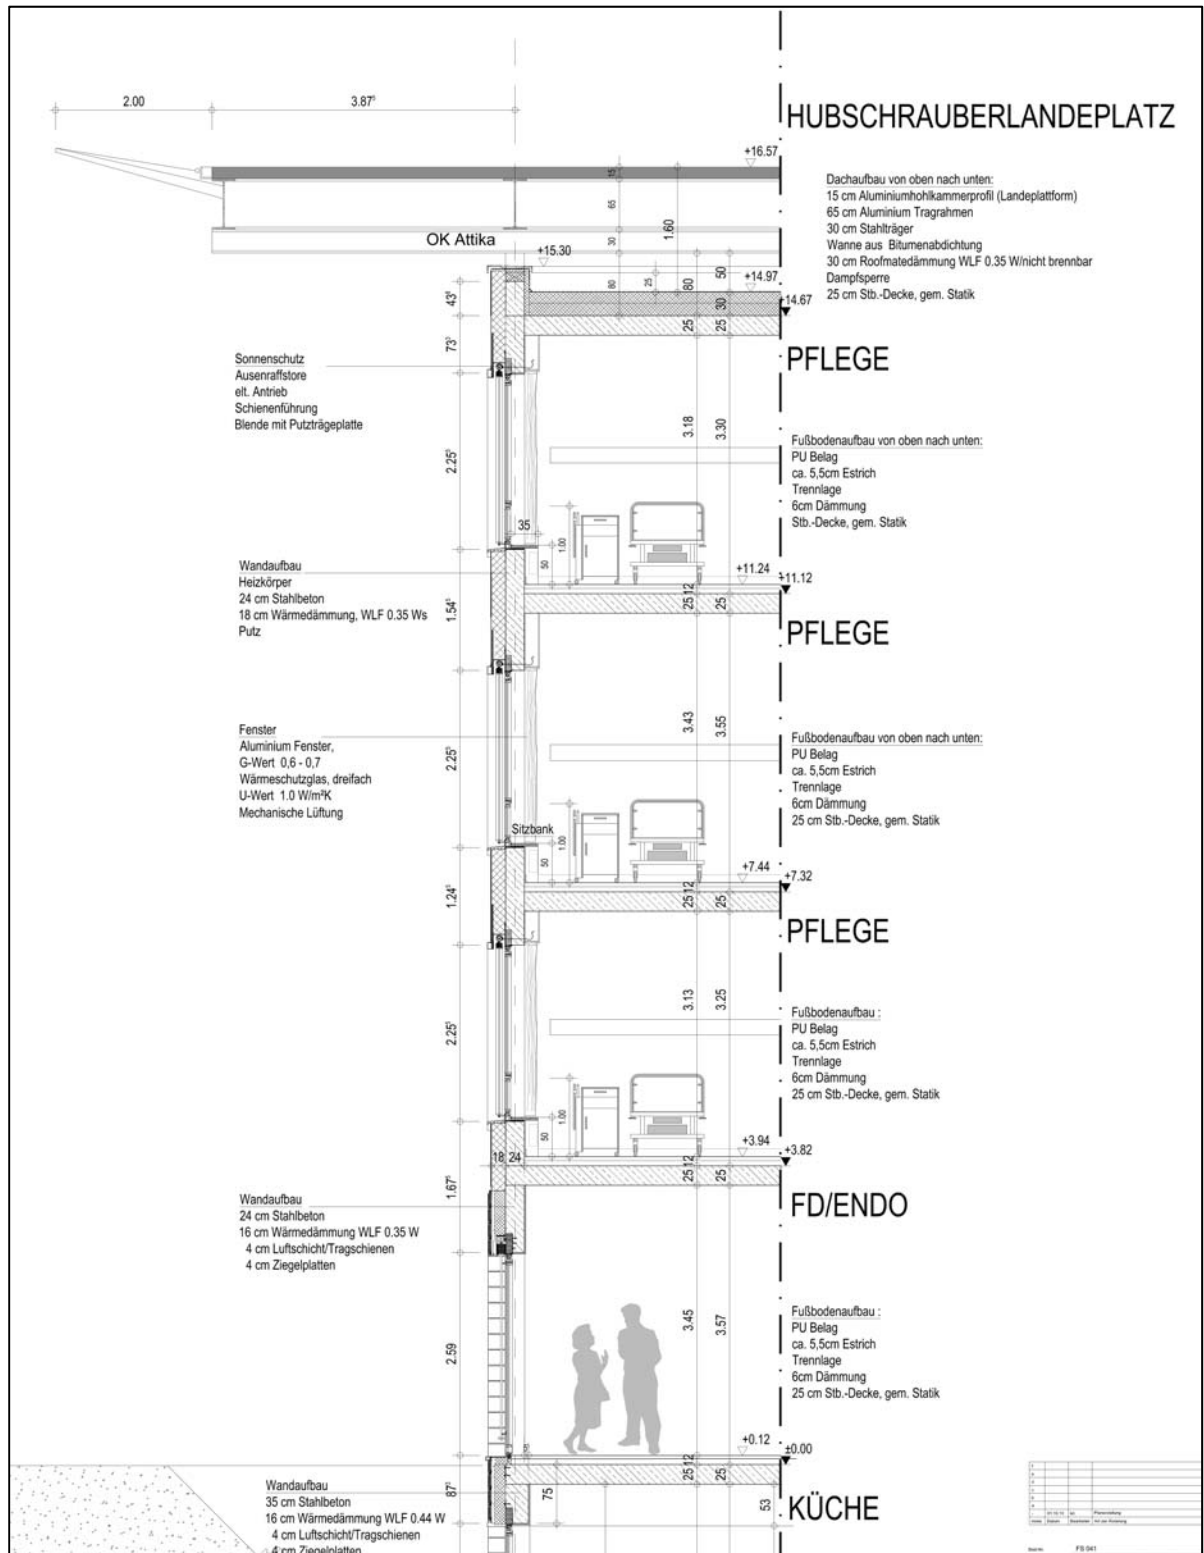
Fassadenschnitt des geplanten Bettenhauses /13/
